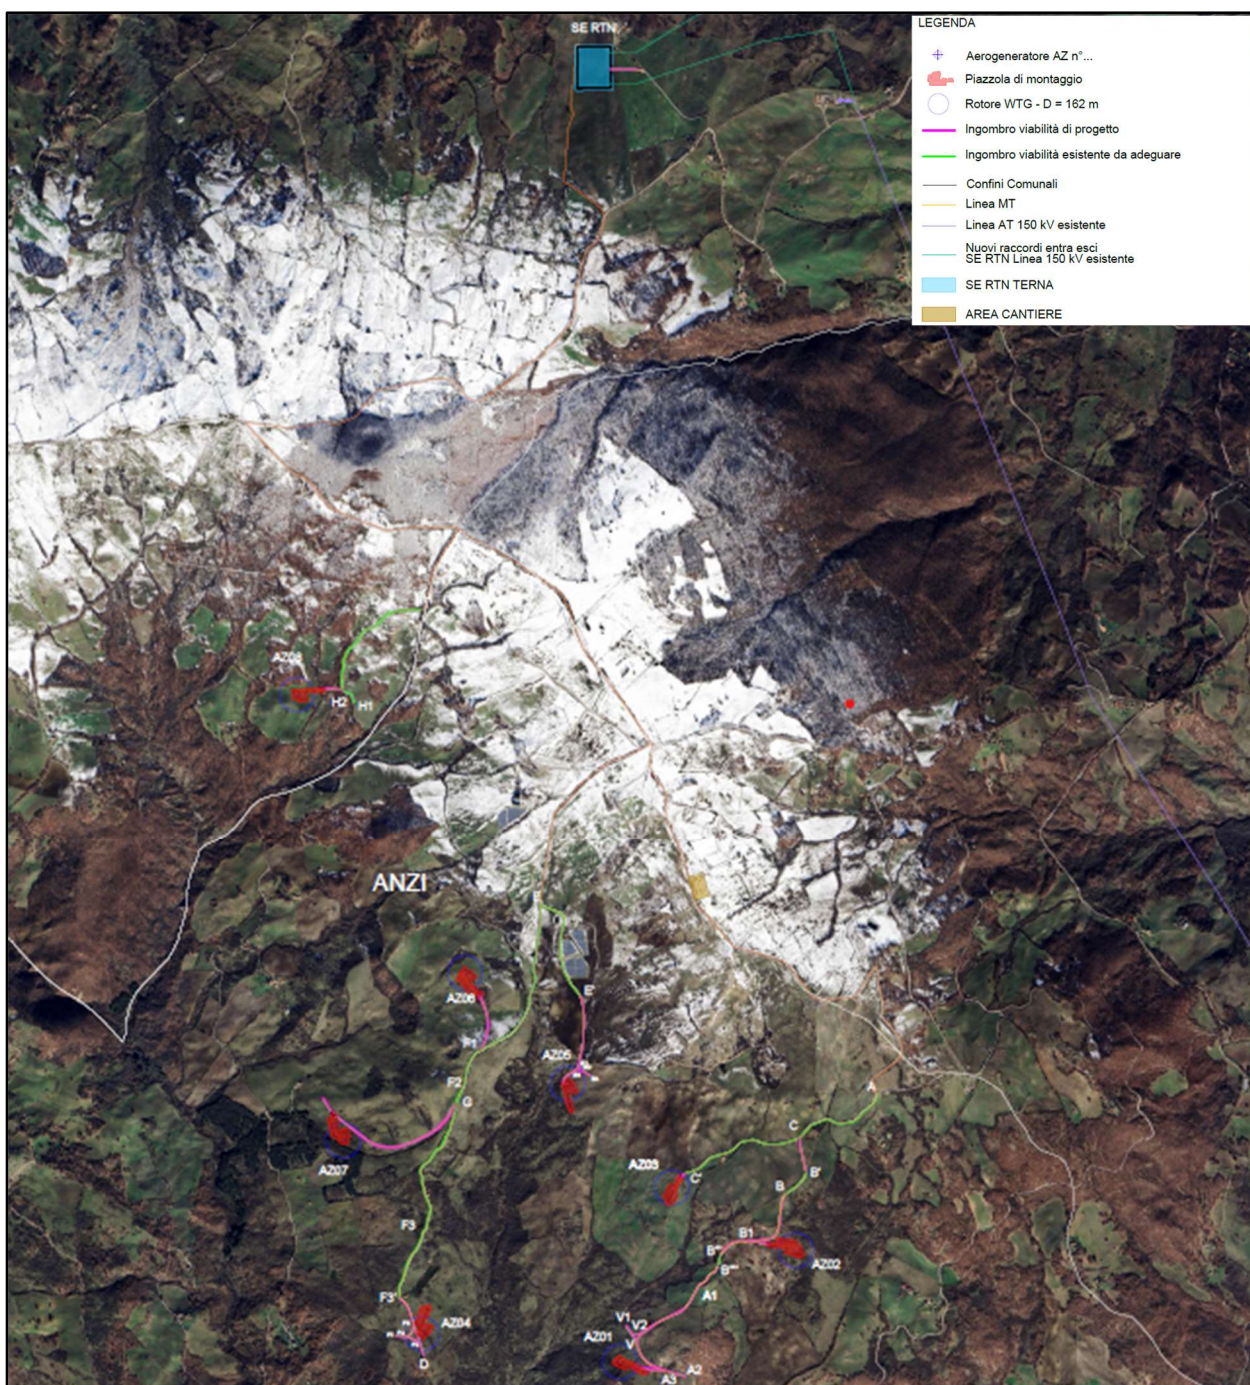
Planimetria viabilità in fase di costruzione e montaggio
